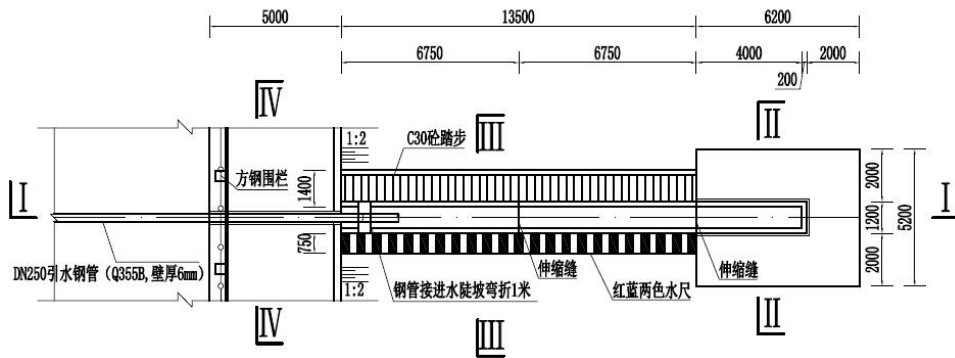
2#调蓄水池进水陡坡、消力池平面图 (单位: mm)
